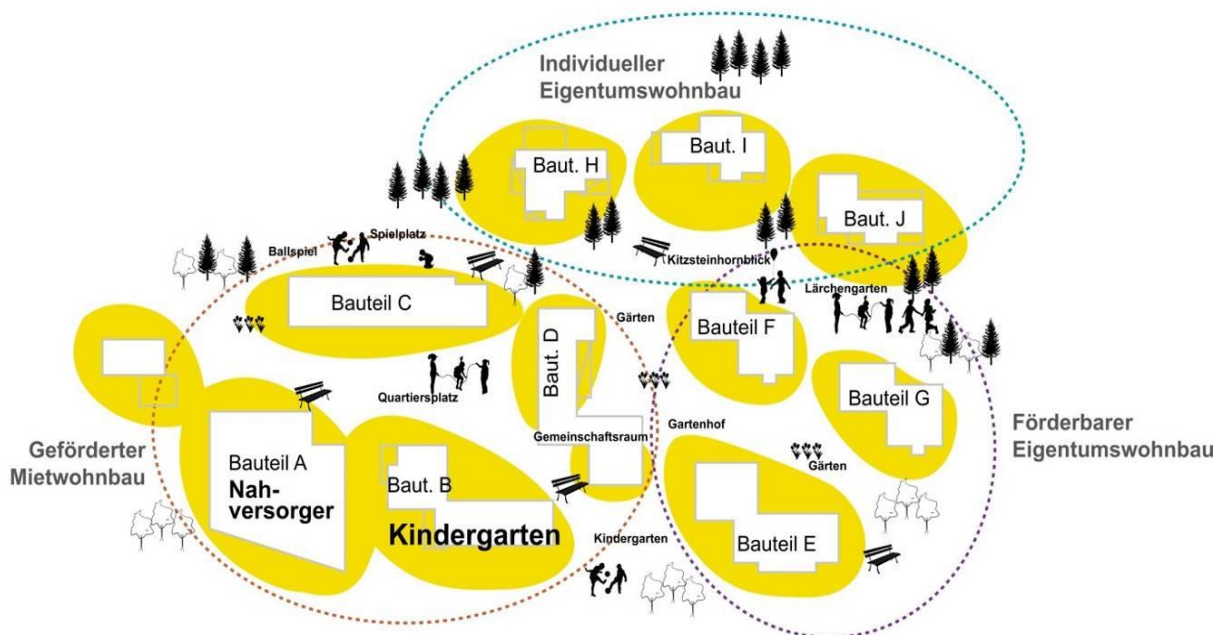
Lageplan Sonnengarten Limberg (Habitat, 2020)
